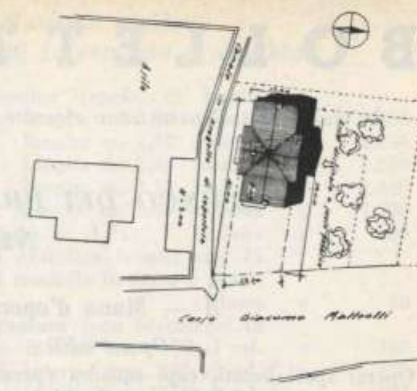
Planimetria: Motto "Nord-Sud C".
